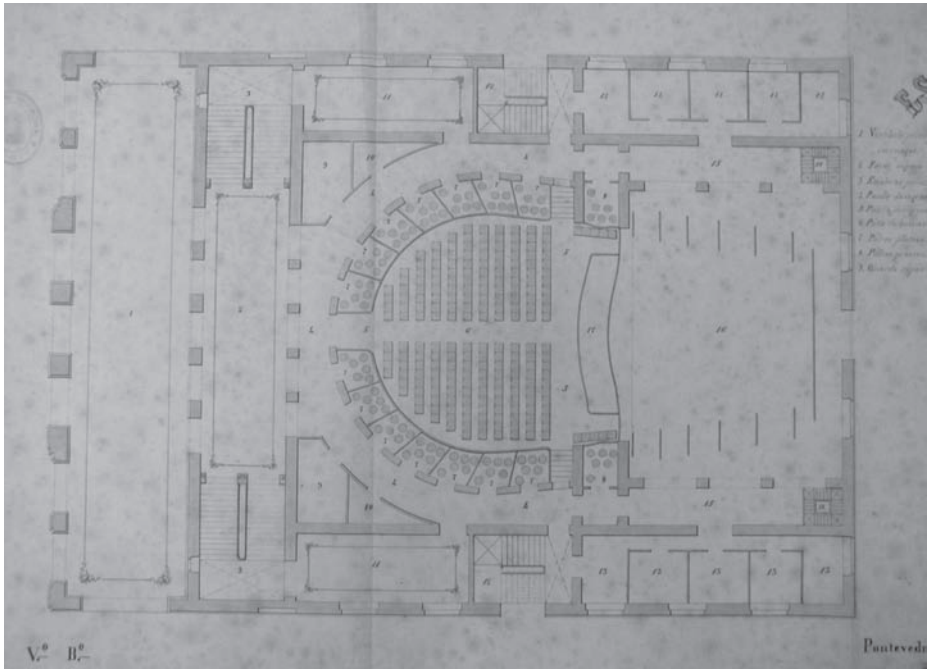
Proyecto del Teatro Cervantes o Rosalía. Planta baja. A.R. Sesmero. 1881.
